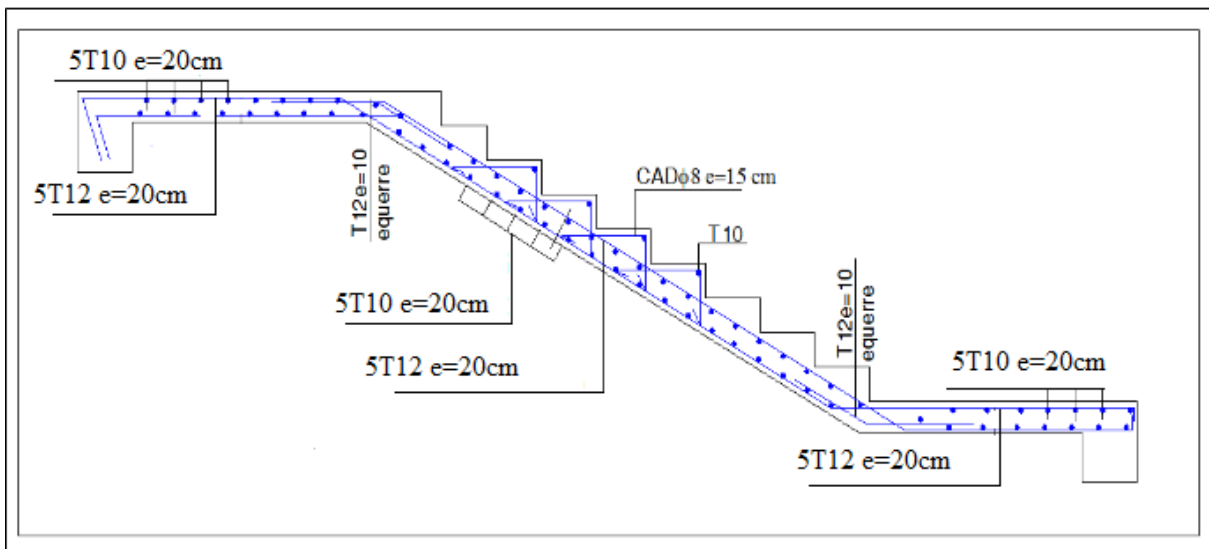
Schéma de ferrailage des escaliers RDC et Etage courant.
